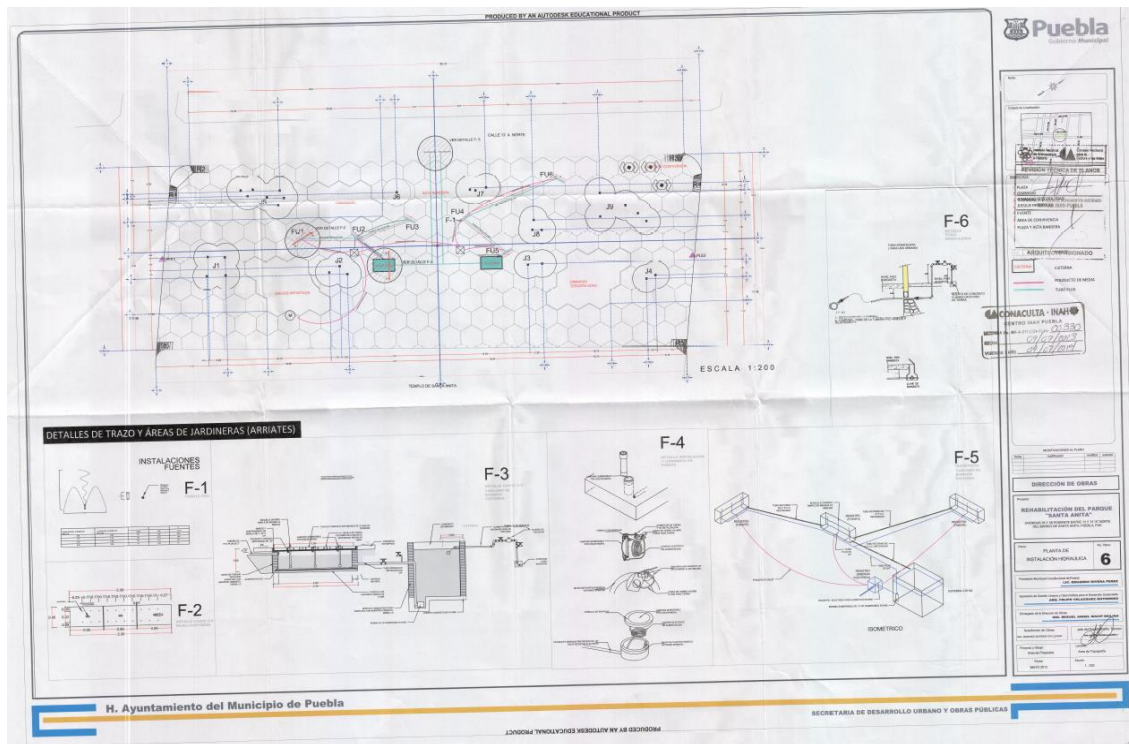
Plano 6. Distribución de las fuentes de agua en la plaza cívica y detalles constructivos y de instalaciones.
